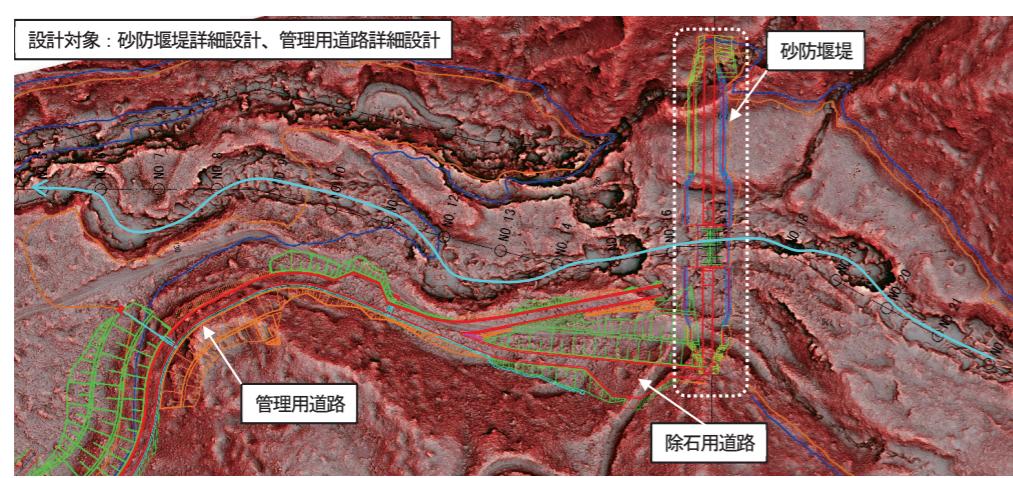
赤色立体地図を背景とした砂防堰堤計画平面図
